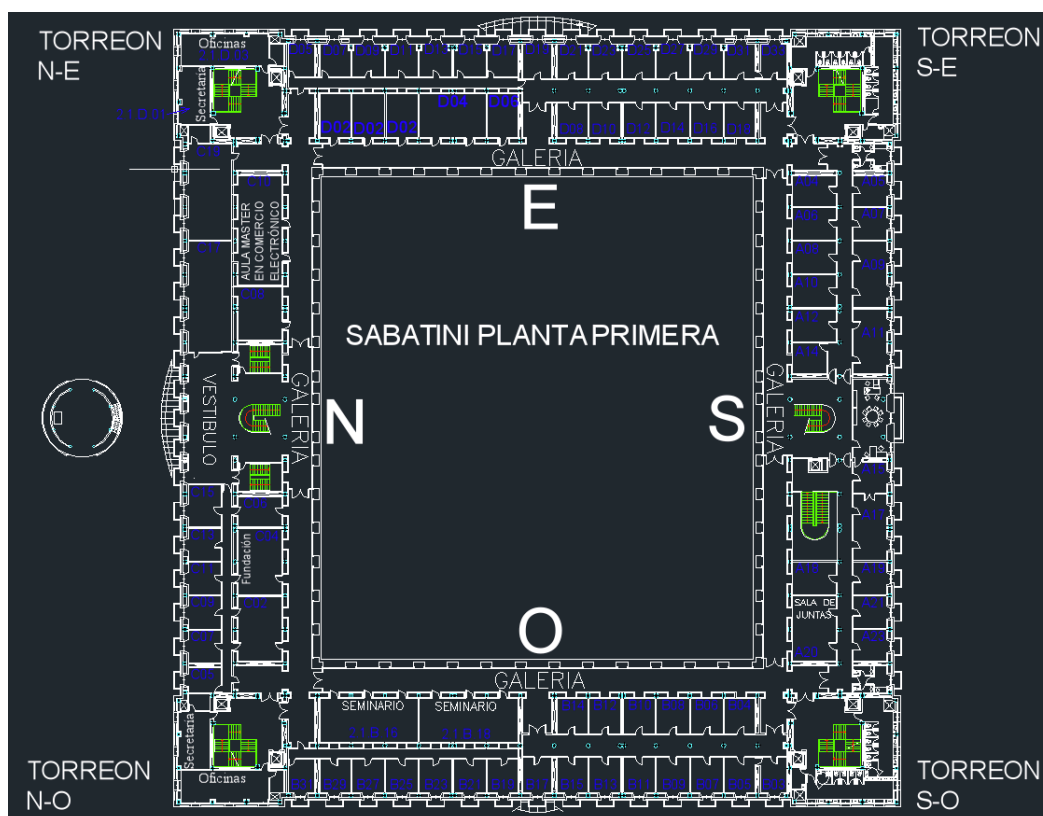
Vista en planta de la planta primera, edificio Sabatini - AutoCAD
